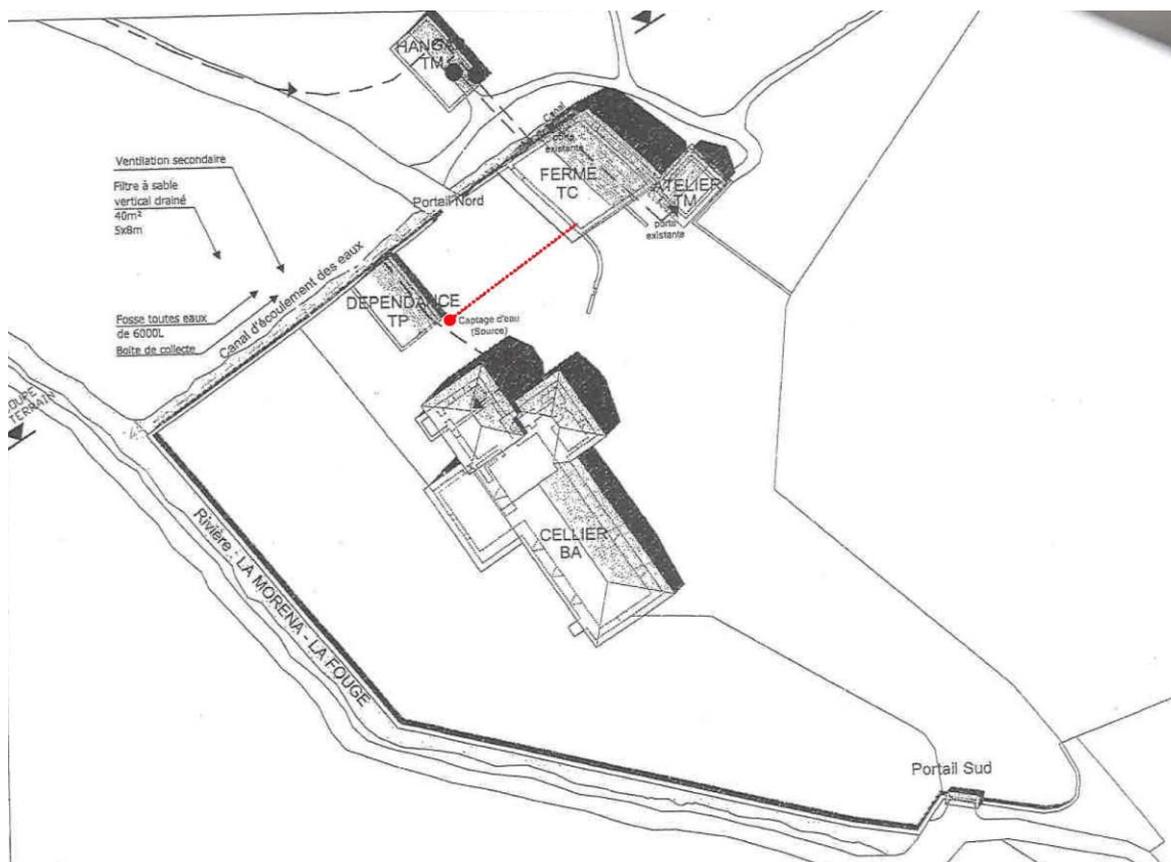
Plan masse du projet de réhabilitation du domaine d'Epierre. Source : Bruno Morel Architecte
